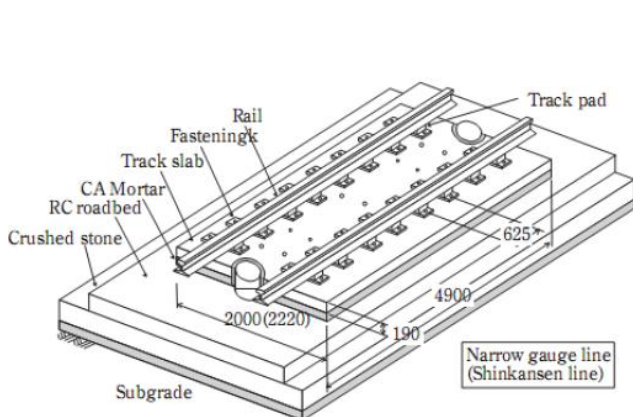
Laje Pré Fabricada - Shinkansen Slab Track (Esquema) [56]
